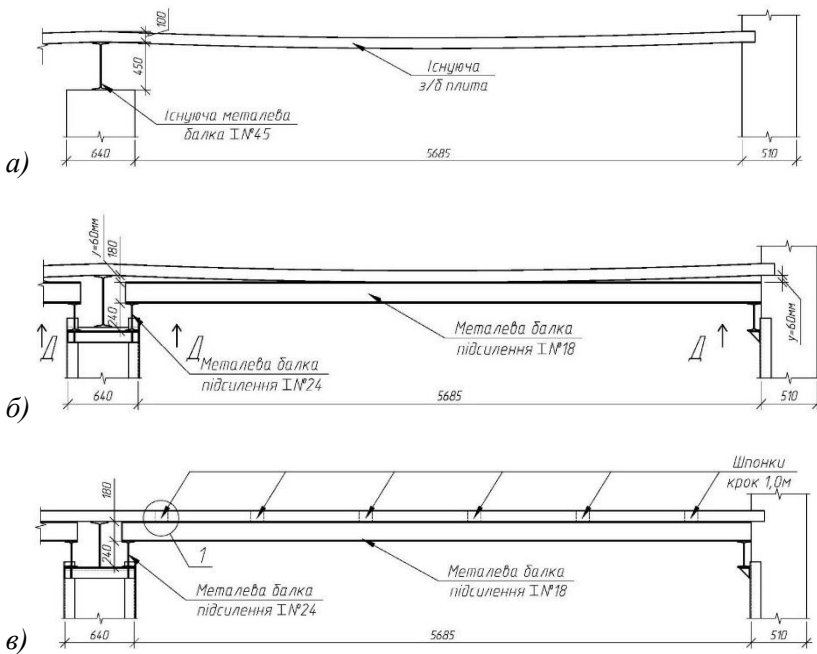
Схеми підсилення залізобетонного перекриття: а) – вигляд залізобетонного перекриття до підсилення; б) – влаштування підсилення сталевими балками; в) – забезпечення сумісної роботи залізобетонної плити і сталеві балки
